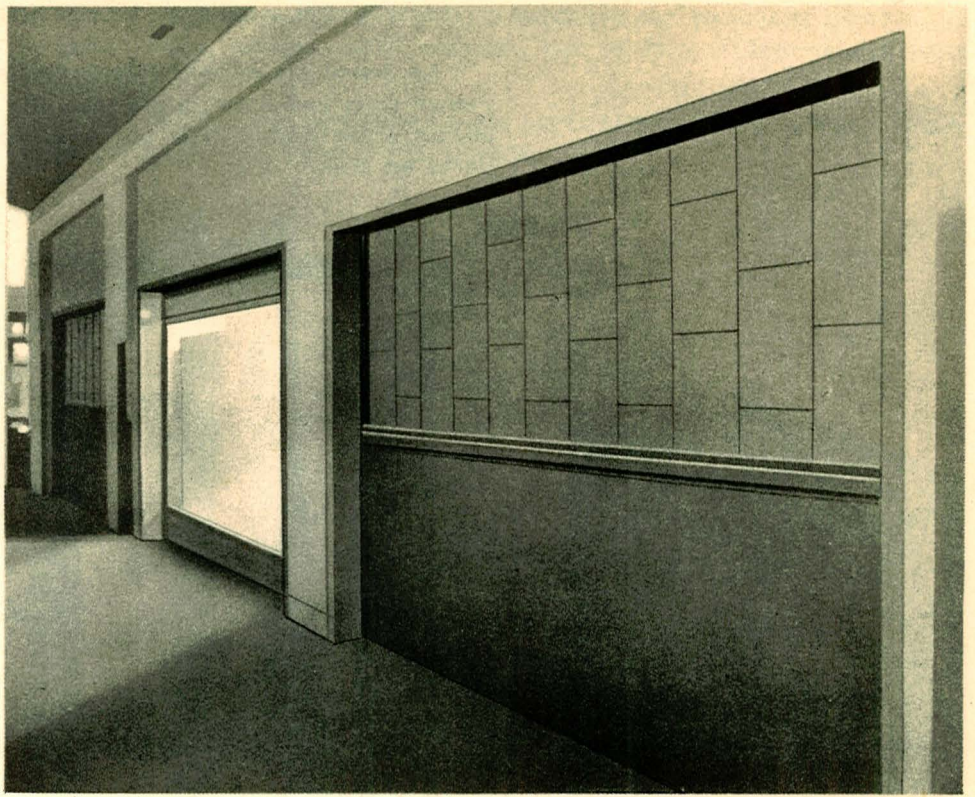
Extrait des publications de RICHMOND FIRE PROOF DOORS Co.
